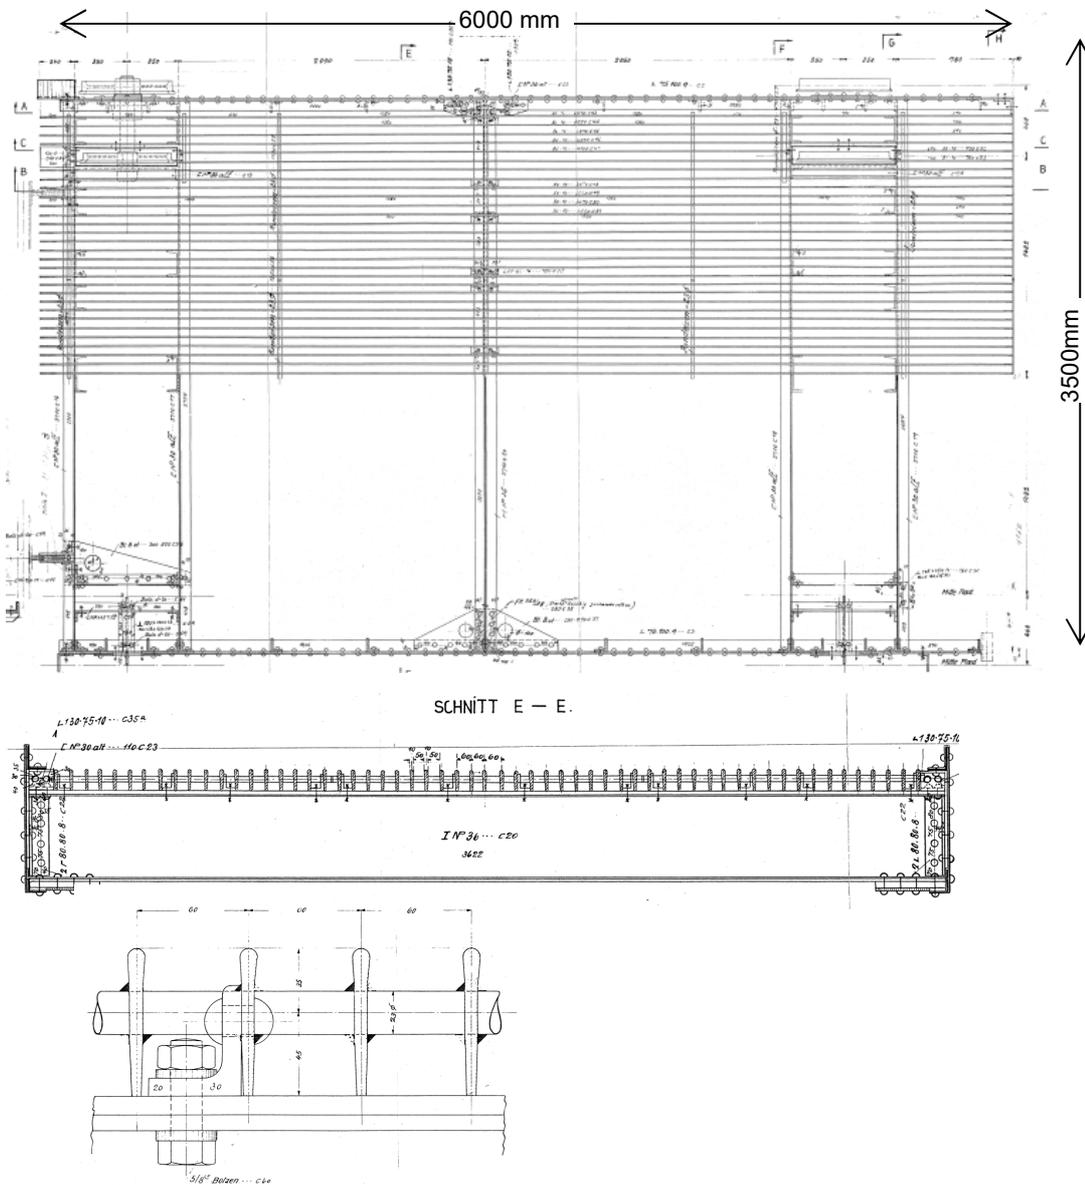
Konstruktionsdetails Rechenfeld (Ausschnitt aus Plan 2153; Fa. MAN, 31.10.1932)
